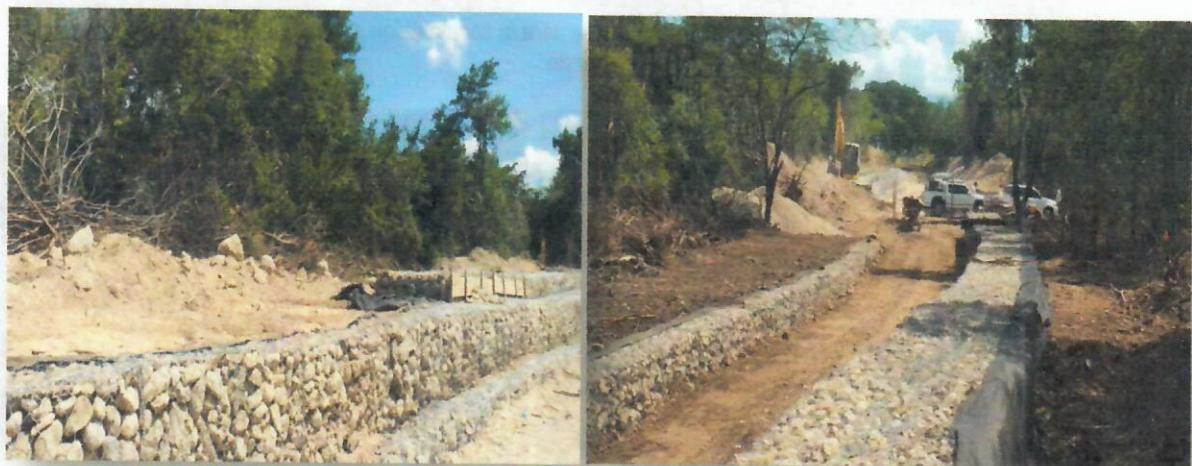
Material forestal intervenido por maquinaria para la construcción de gaviones, punto 12, Arroyo Pozo Hondo
